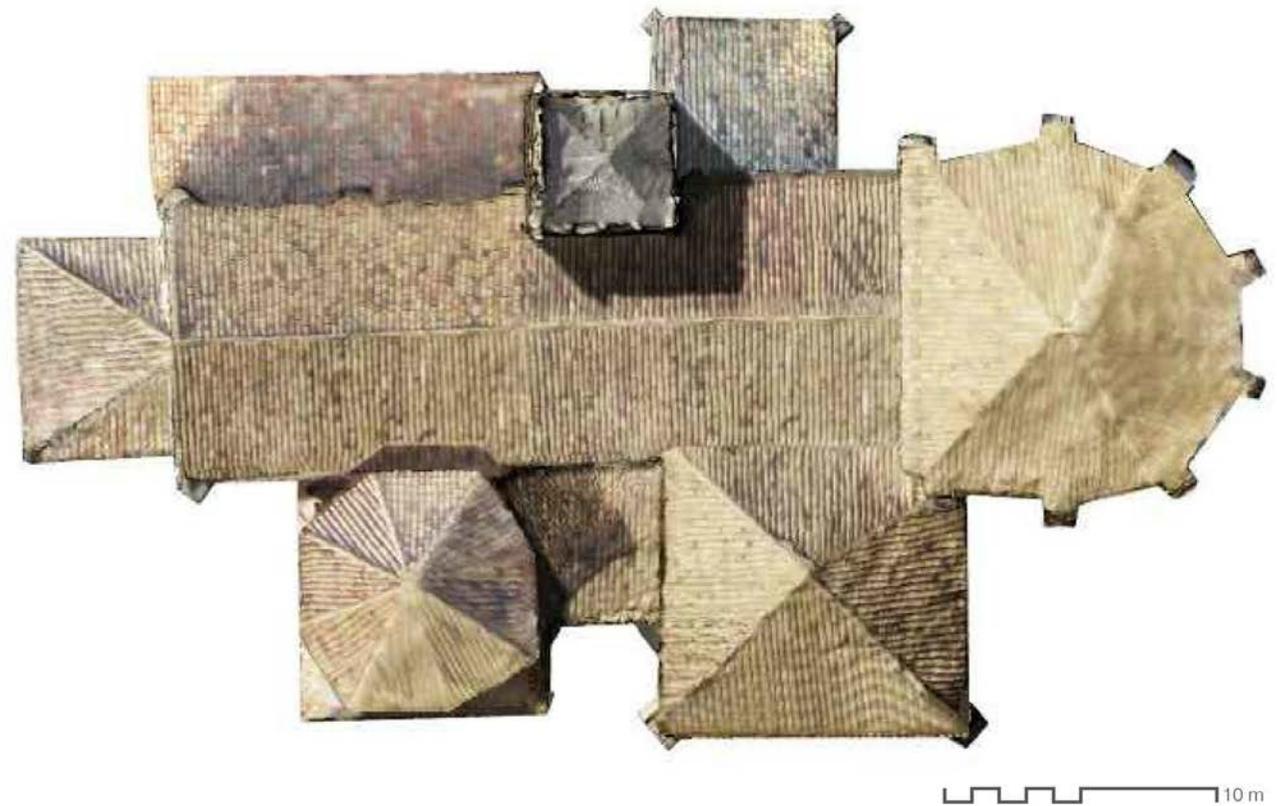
Planta de cubiertas. Fuente: elaboración propia.
